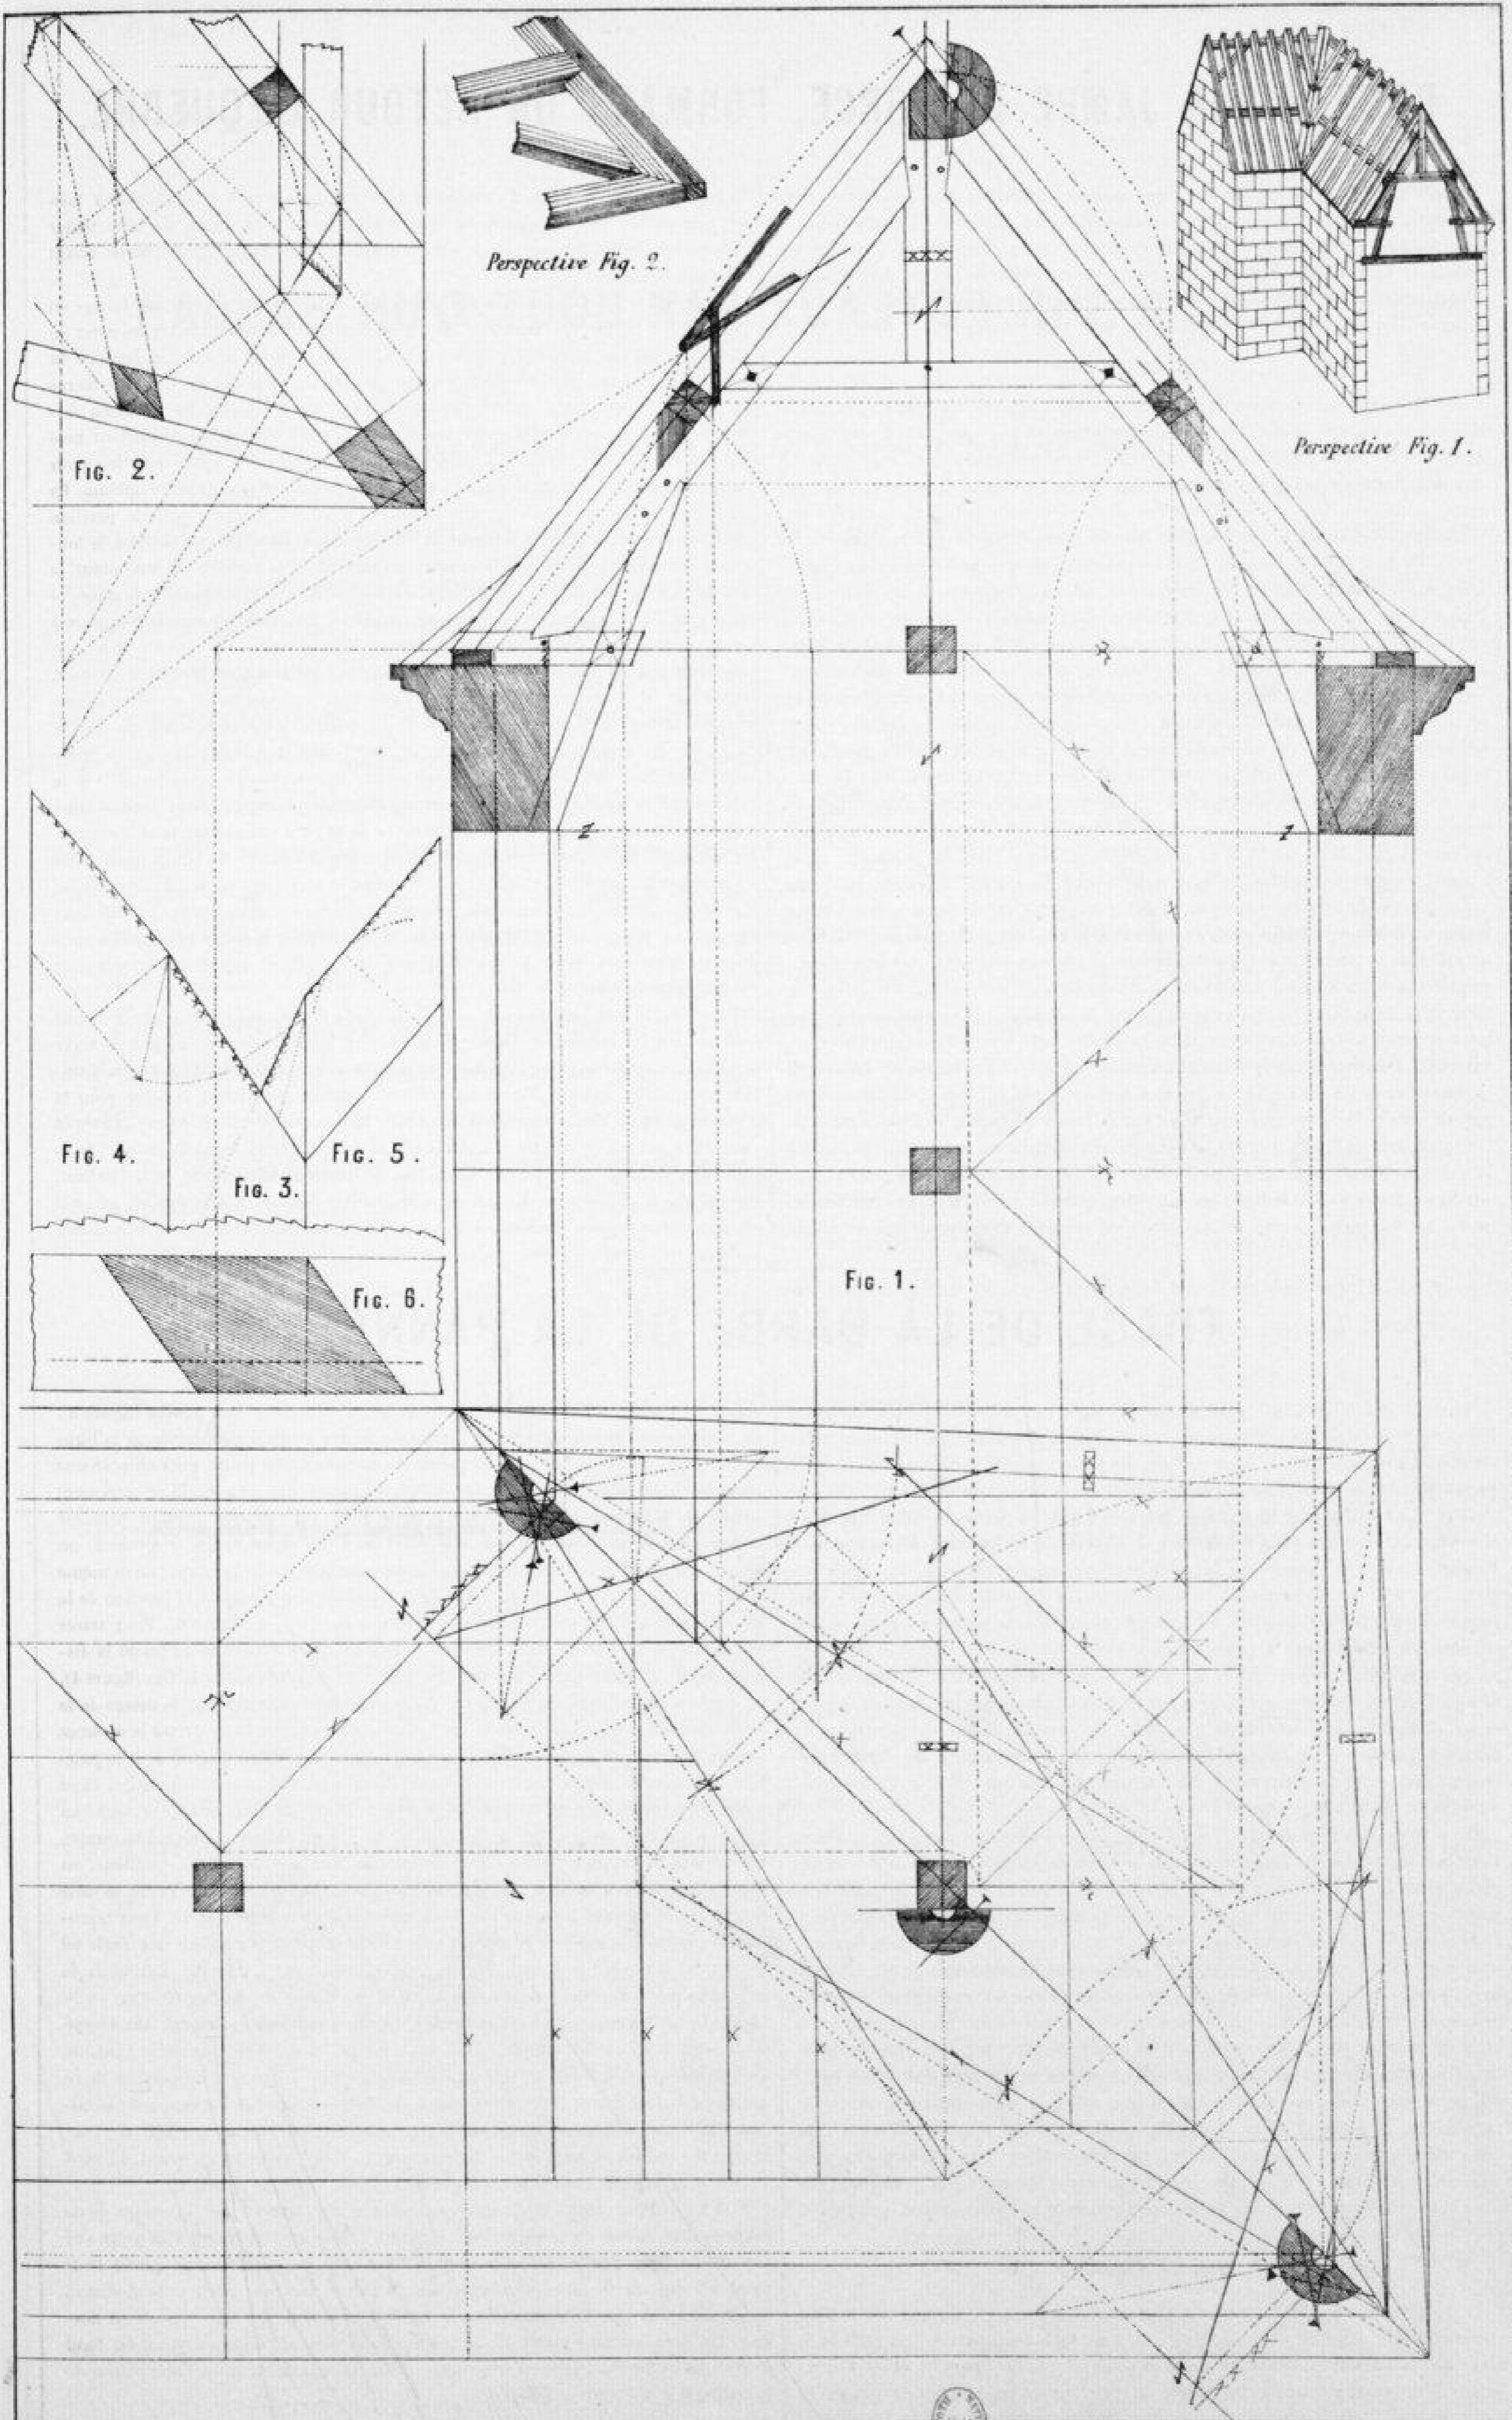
FIGURE I. CROUPE SUR POTEAUX PAR BOUT D'UN HANGAR
